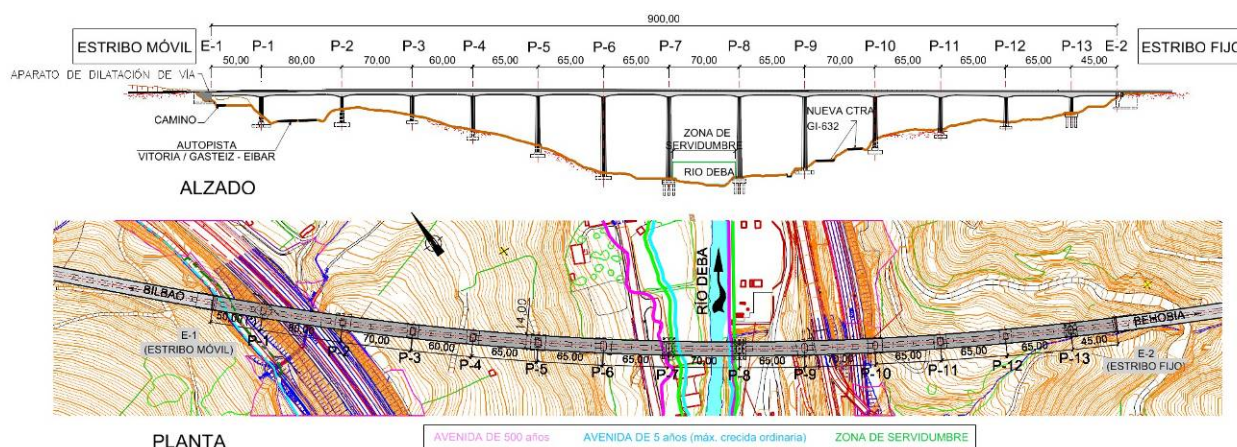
Alzado y planta de la solución construida de hormigón pretensado
